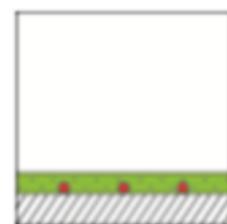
NB3 – Verbundkonstruktion: Rohrsystem auf Altuntergrund in Ausgleichsmasse/-estrich
